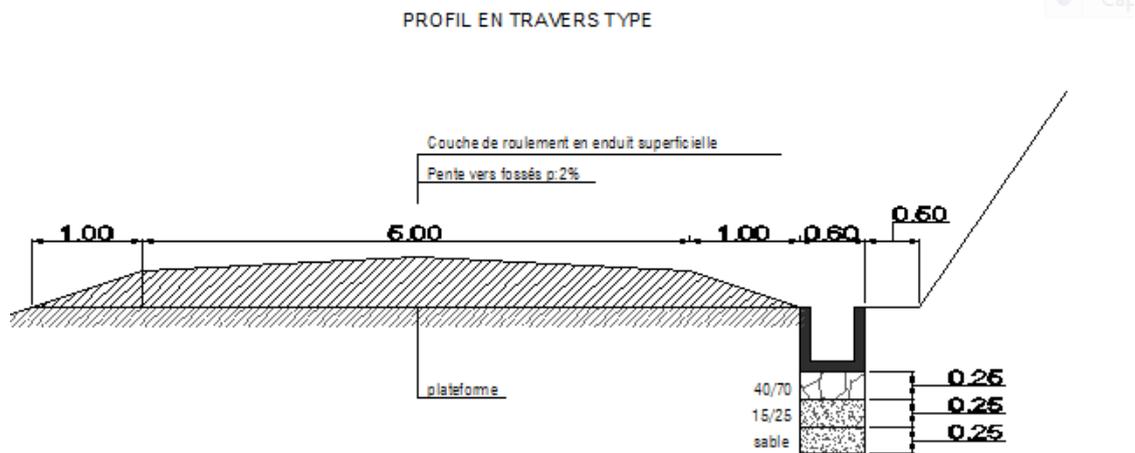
PROFIL EN TRAVERS TYPE AVEC EXÉCUTION DRAIN
